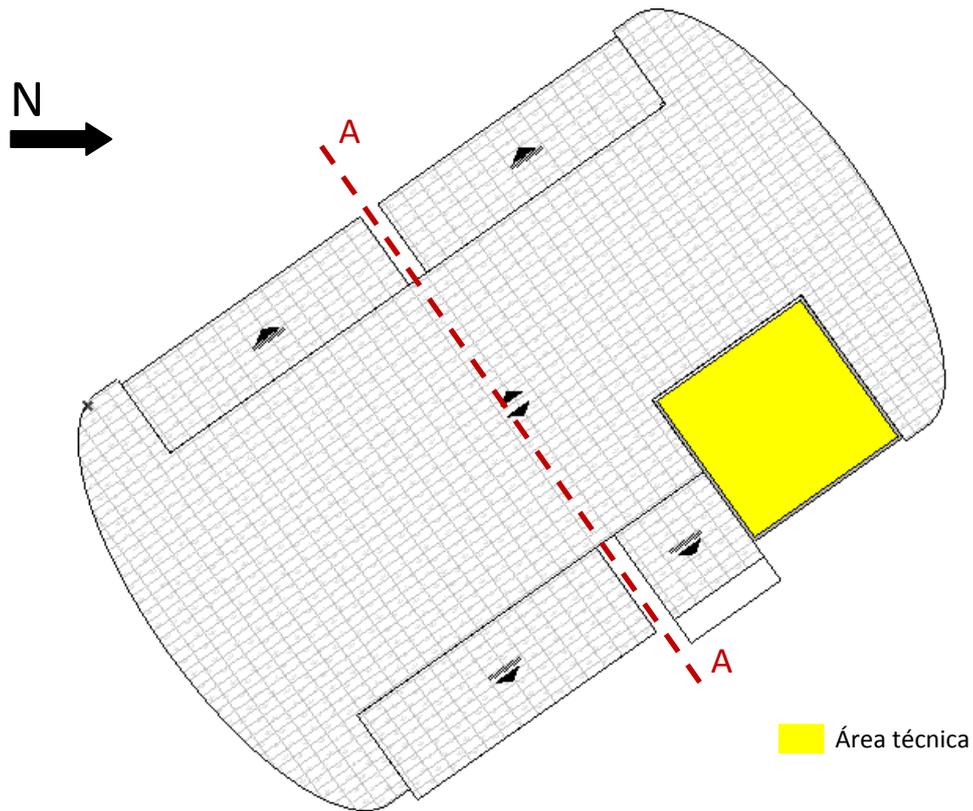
Planta de cobertura esquemática do NEM-CAR e sua setorização.
